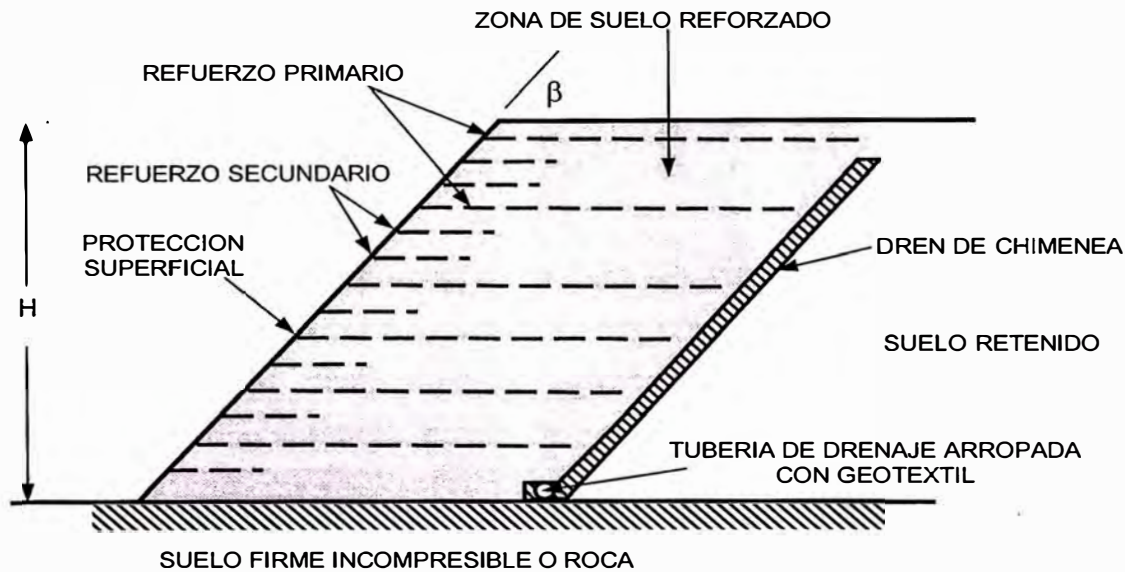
Sección típica de un muro de suelo reforzado.
